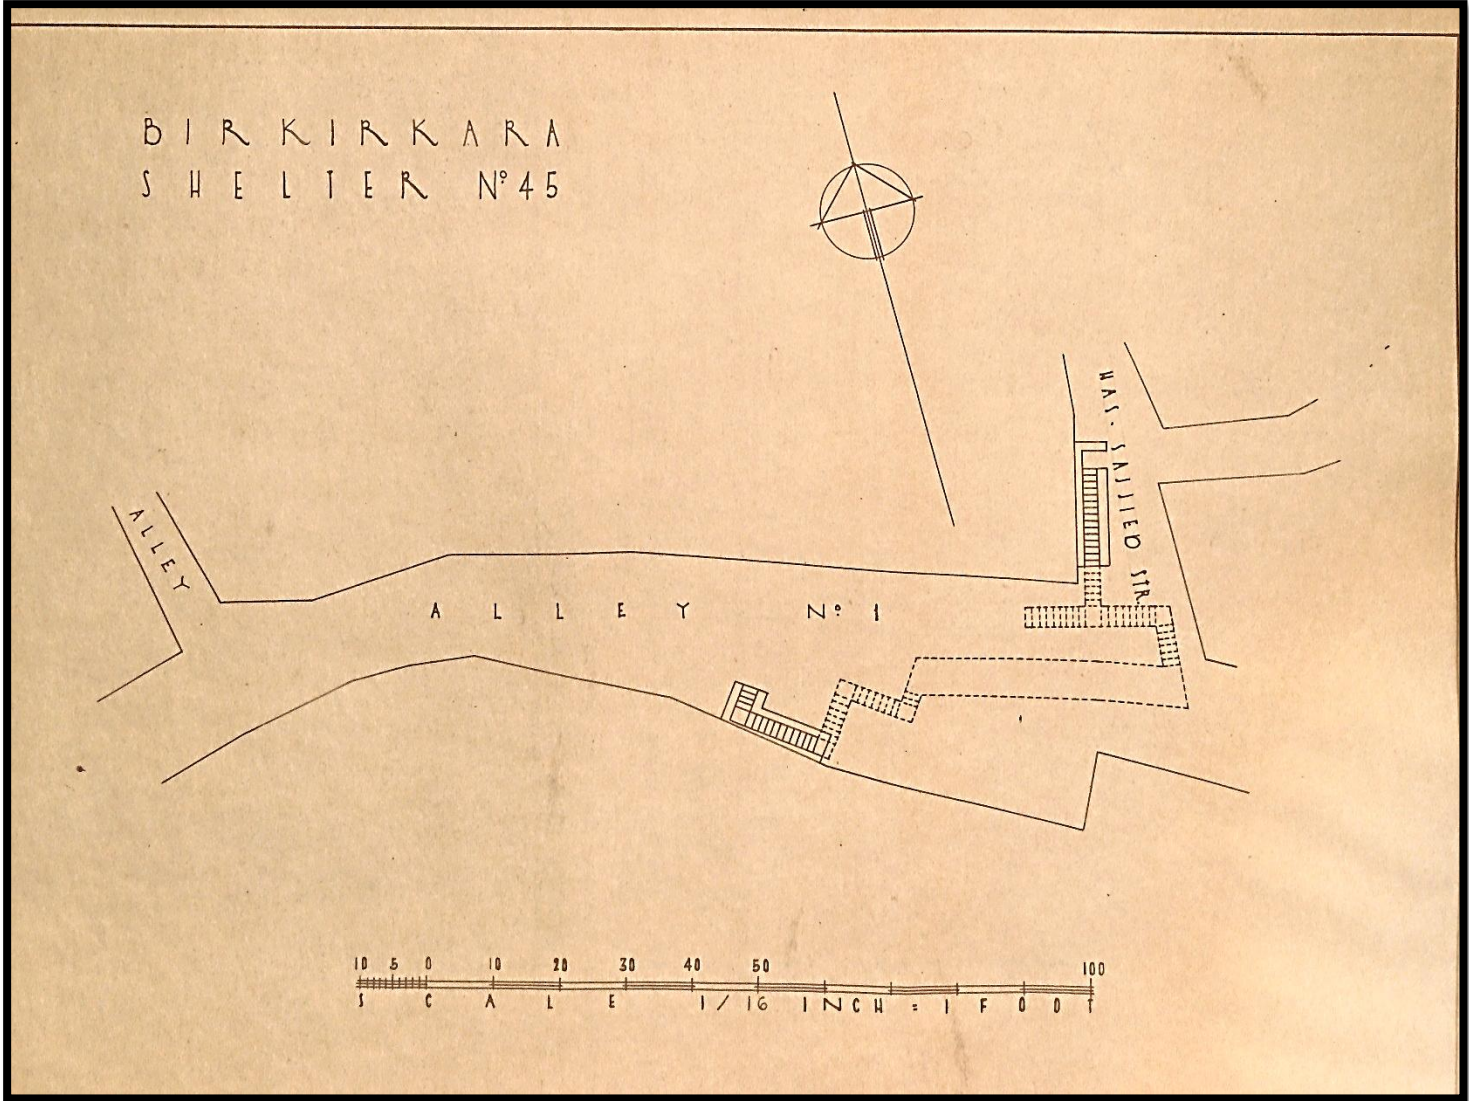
Planta do Abrigo nº 45 "Alley nº1"
